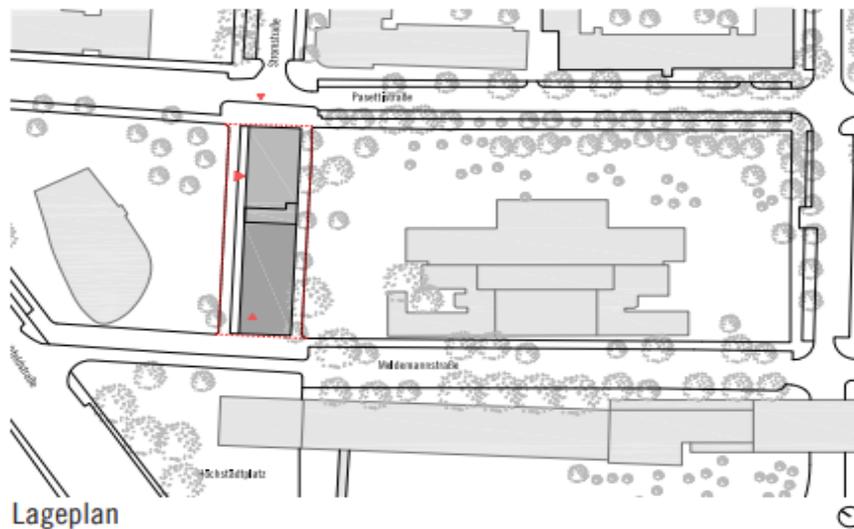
Lageplan Neubau Plusbase (bauliche Variante 4) in der Stromstraße (Quelle POS Architekten)
